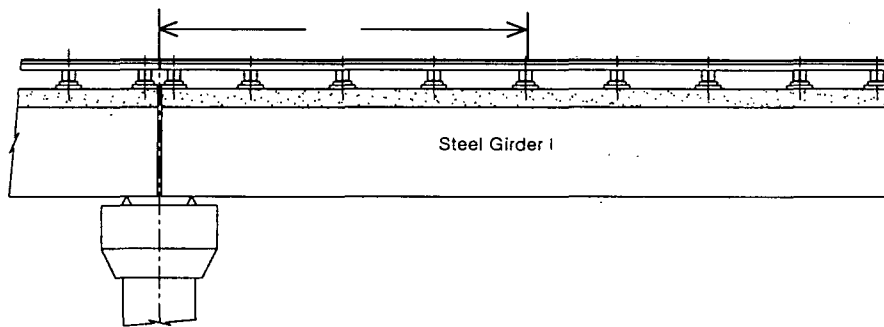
곡선궤도 길이방향의 상부궤도 설치예 (Steel Girder 구간)
